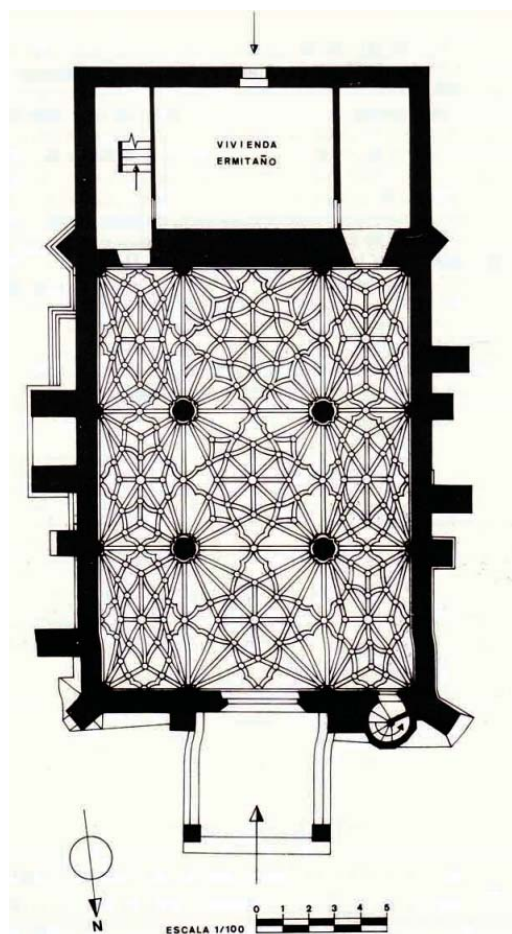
Planta de la ermita de San Jorge (fuente: Jose Luís Pano Gracia)
